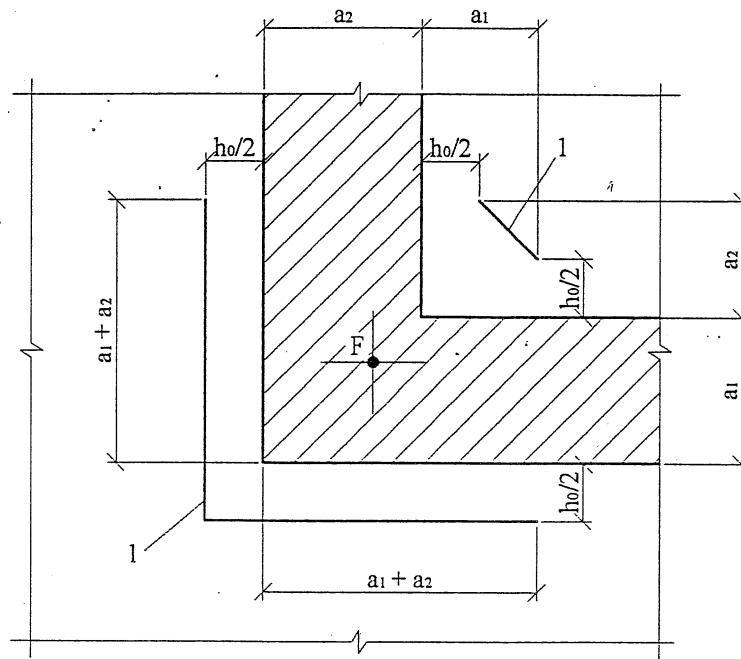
Схема для расчета железобетонной плиты на продавливание около угла стены
